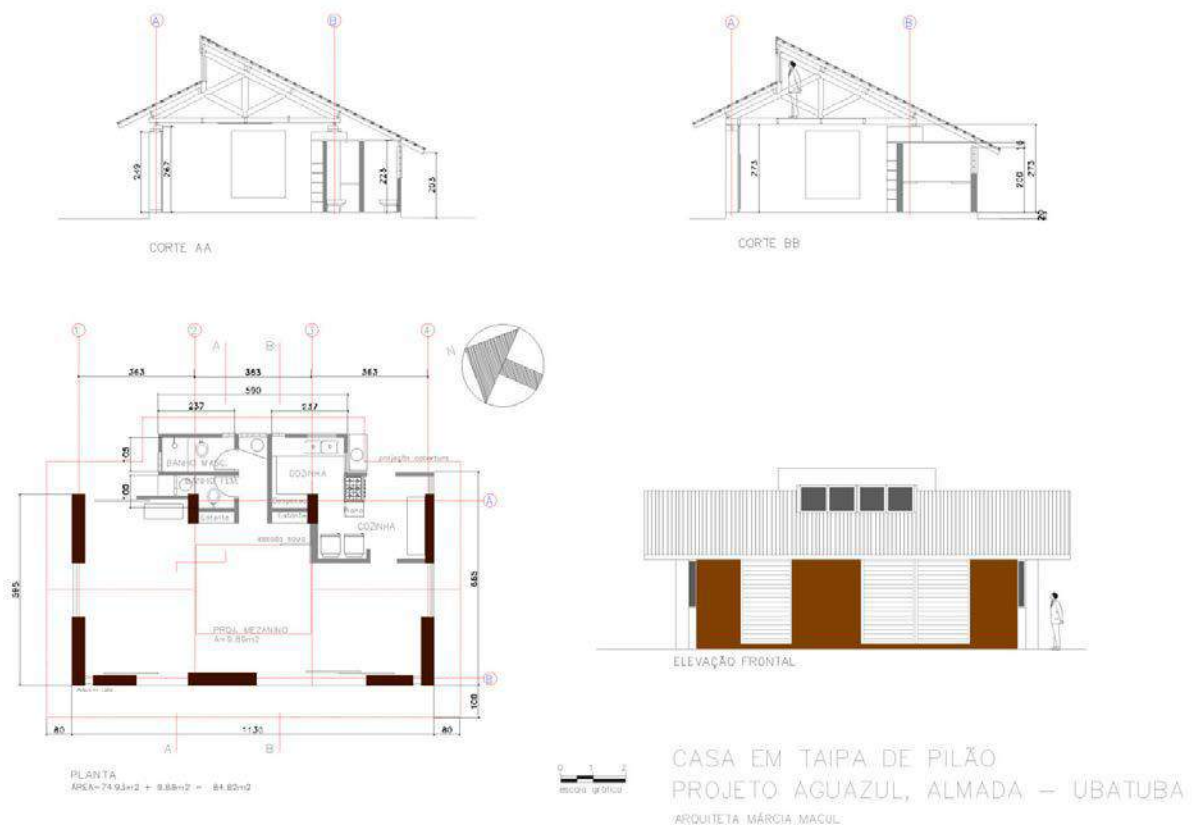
Cortes, planta baixa e vista da casa do Projeto Aguazul
